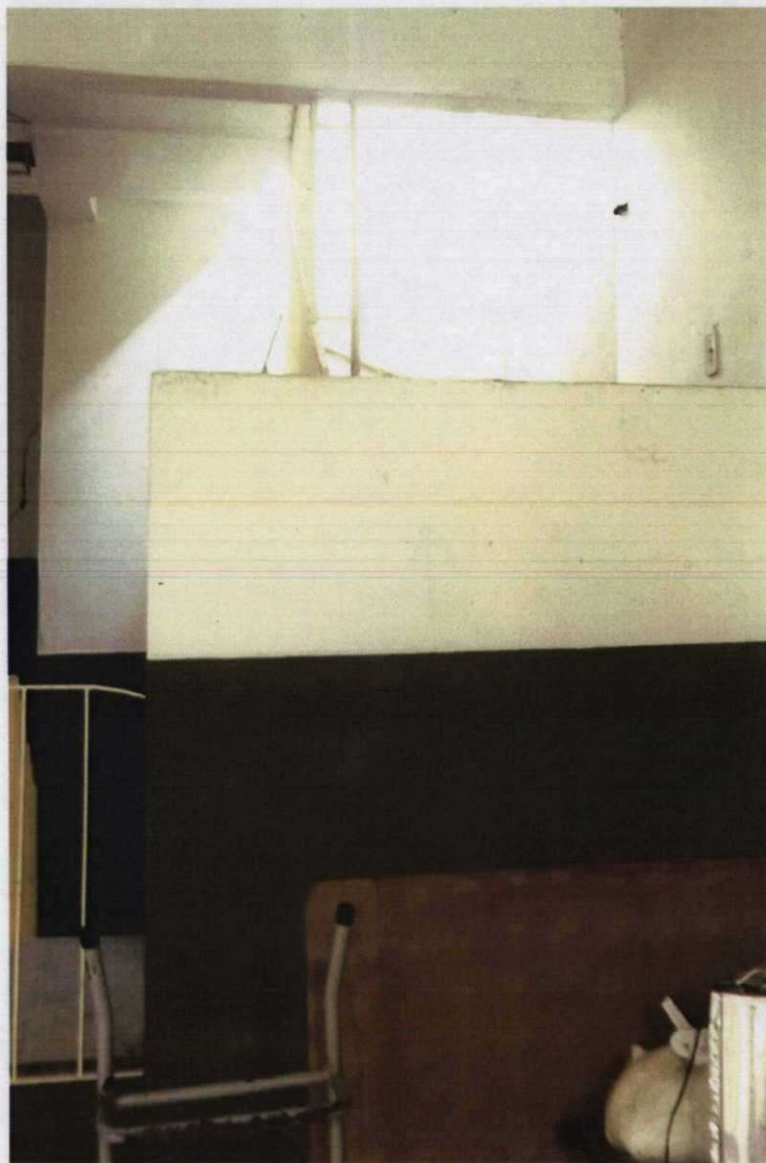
MURETA DE PROTEÇÃO NO PATAMAR DA ESCADA
